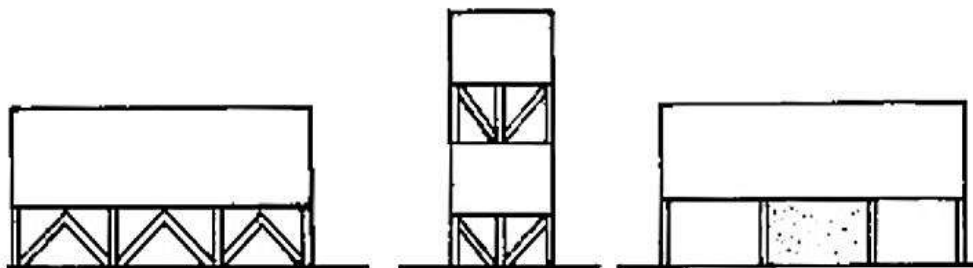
Contreventement des niveaux transparents par des palées de stabilité ou murs de contreventement [17]
